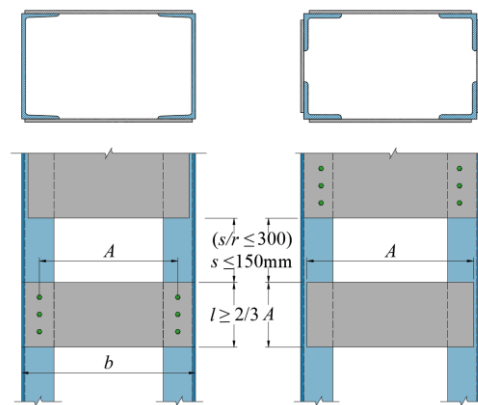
b - Detalles de unión con placas en elementos armados
